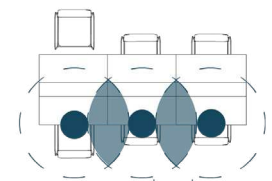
Grundrissvariante 3 - Gemeinschaftlich
